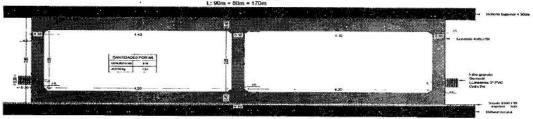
Detalle de la geometría de estructura de entrega pluvial, Box Coulvert de dos cajones, en el Río Guatapurtº.
